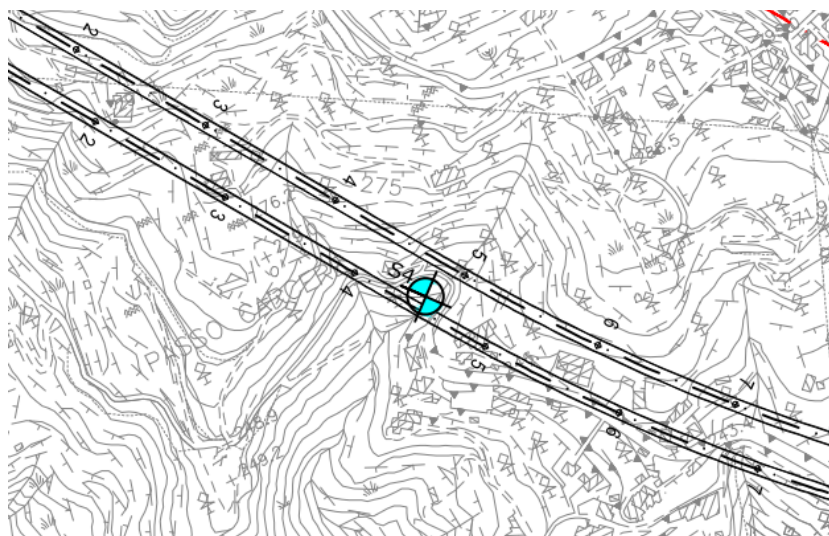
Planimetria con ubicazione del sondaggio S4.
